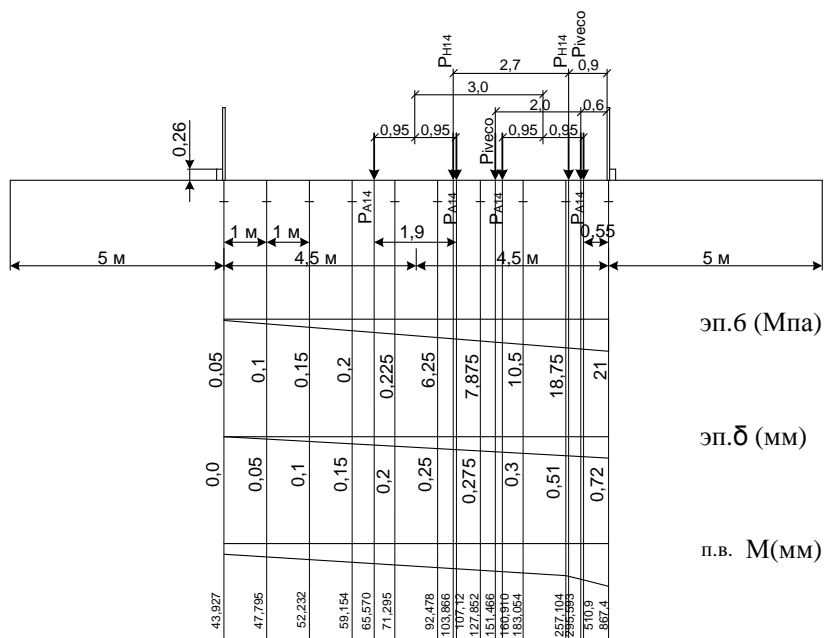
Поперечные схемы загрузки наплавной части комбинированной переправы: эп.σ – эпюра нормальных напряжений в нижнем поясе главных балок под испытательной нагрузкой; эп.δ – эпюра прогибов главных балок под испытательной нагрузкой; п.в.М – след поверхности влияния изгибающего момента в расчетном сечении для определения коэффициента Δ
